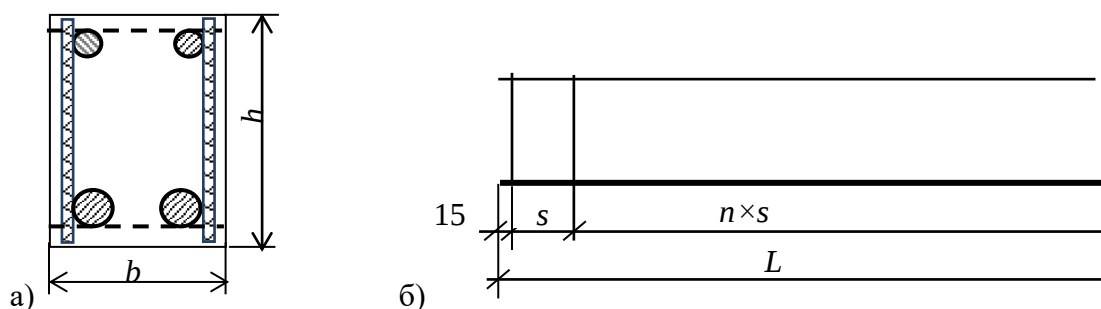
Схема расстановки: а – арматурного каркаса в сечении; б - поперечных стержней
